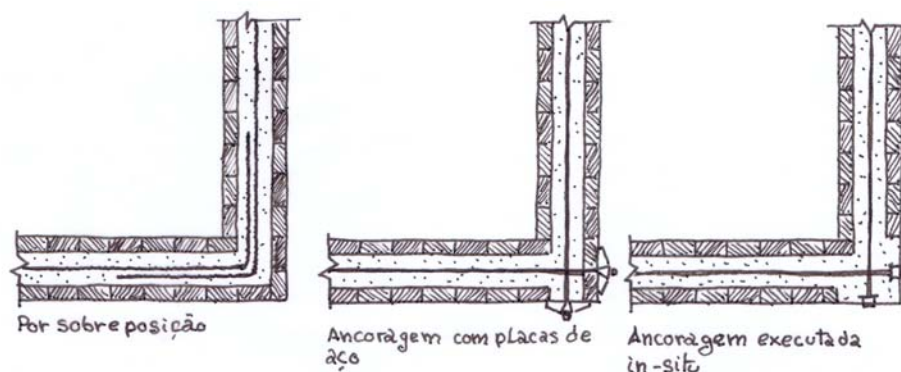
| Esquemas de reforços de ligações entre paredes transversais de canto (adaptado de [11, 15])
